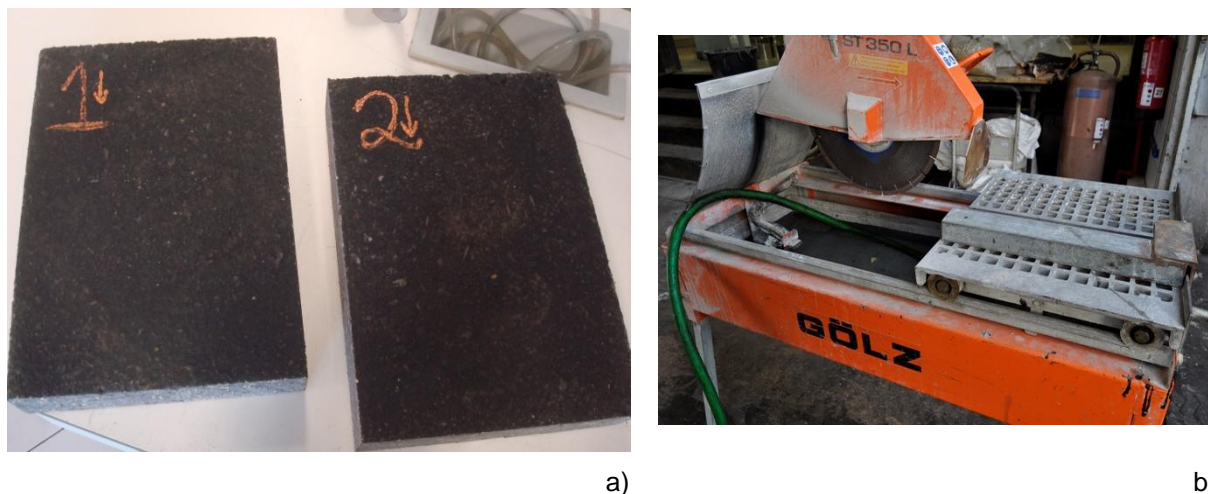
a) Provete desmoldados e serrados; b) Equipamento de serragem (Laboratório NIDIn)
